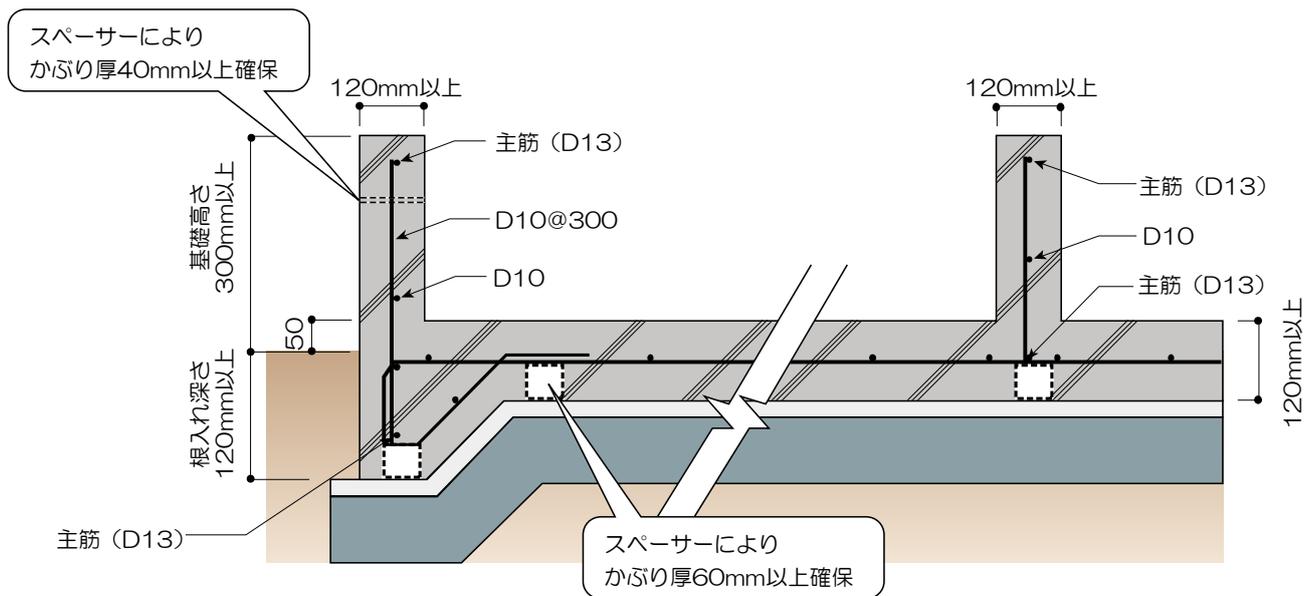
1 ベた基礎の配筋例（シングル配筋の場合）
